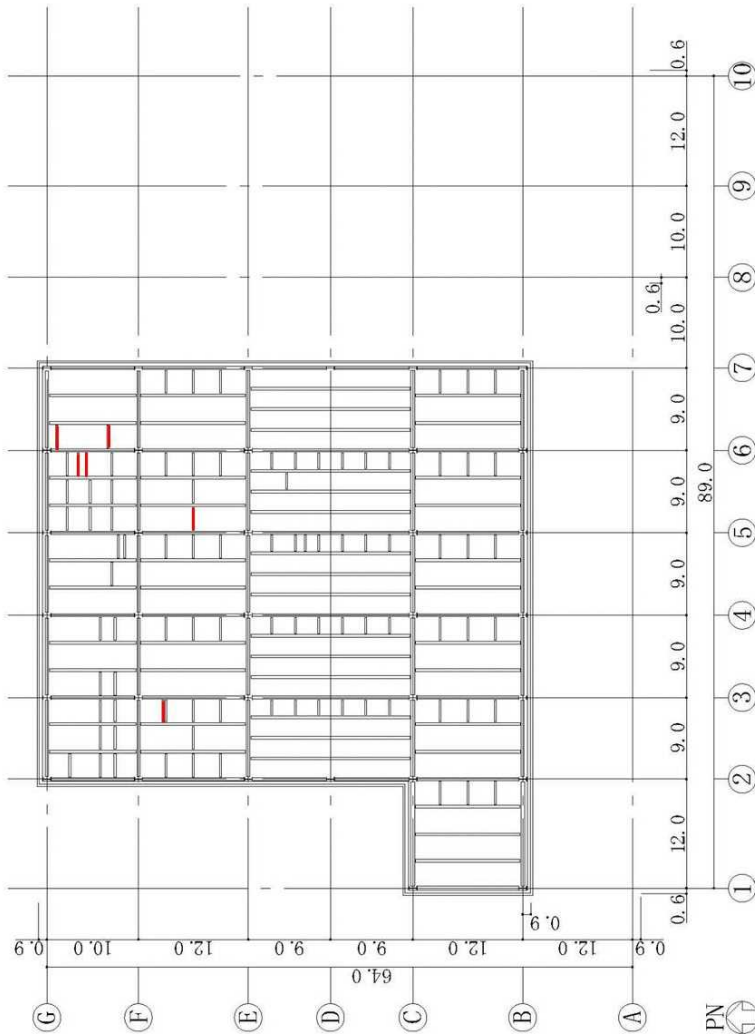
屋上階平面図 (G.L. +12.3) (単位 : m)
